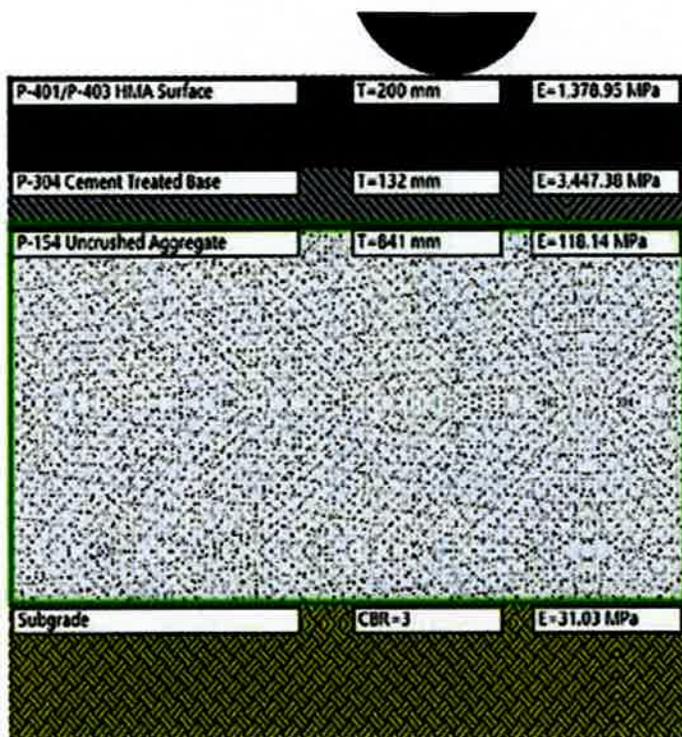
Resumen estructura de pavimento flexible con base estabilizada con cemento.
